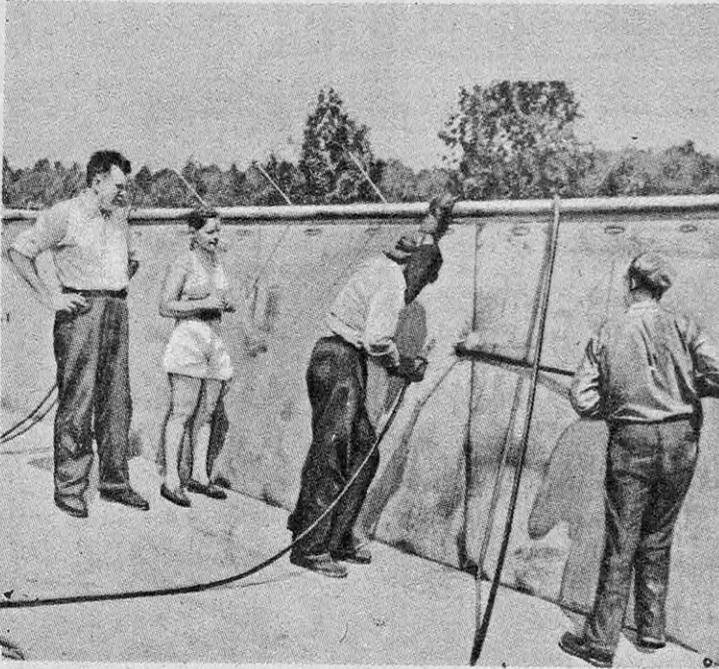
LE TRAVAIL D'ASSEMBLAGE PAR SOUDURE DES PLAQUES D'ACIER CONSTITUANT LES PAROIS DE LA PISCINE
